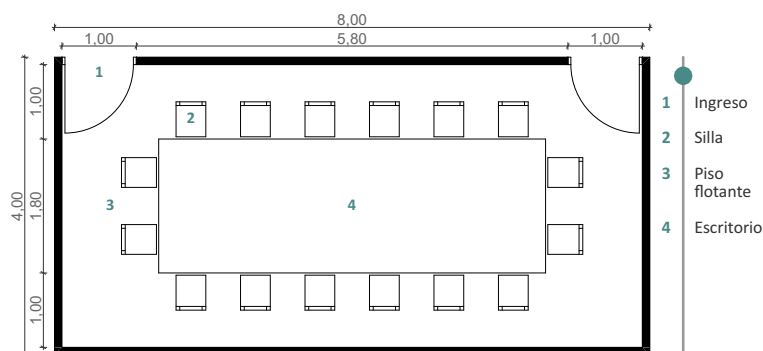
Planta sala de juntas. Fuente: Autores.
